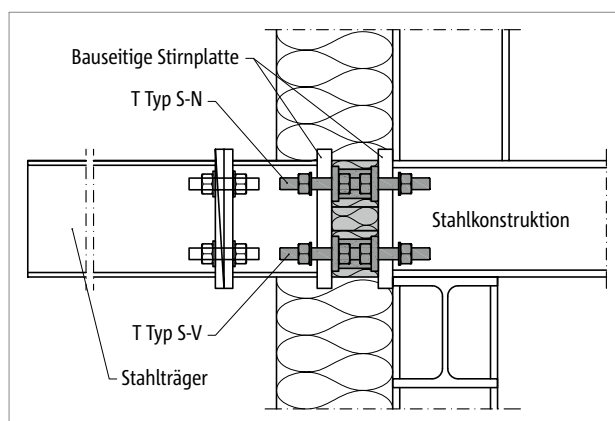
Schöck Isokorb® T Typ S: Stahlkonstruktion frei auskragend; Adapter bauseitig
